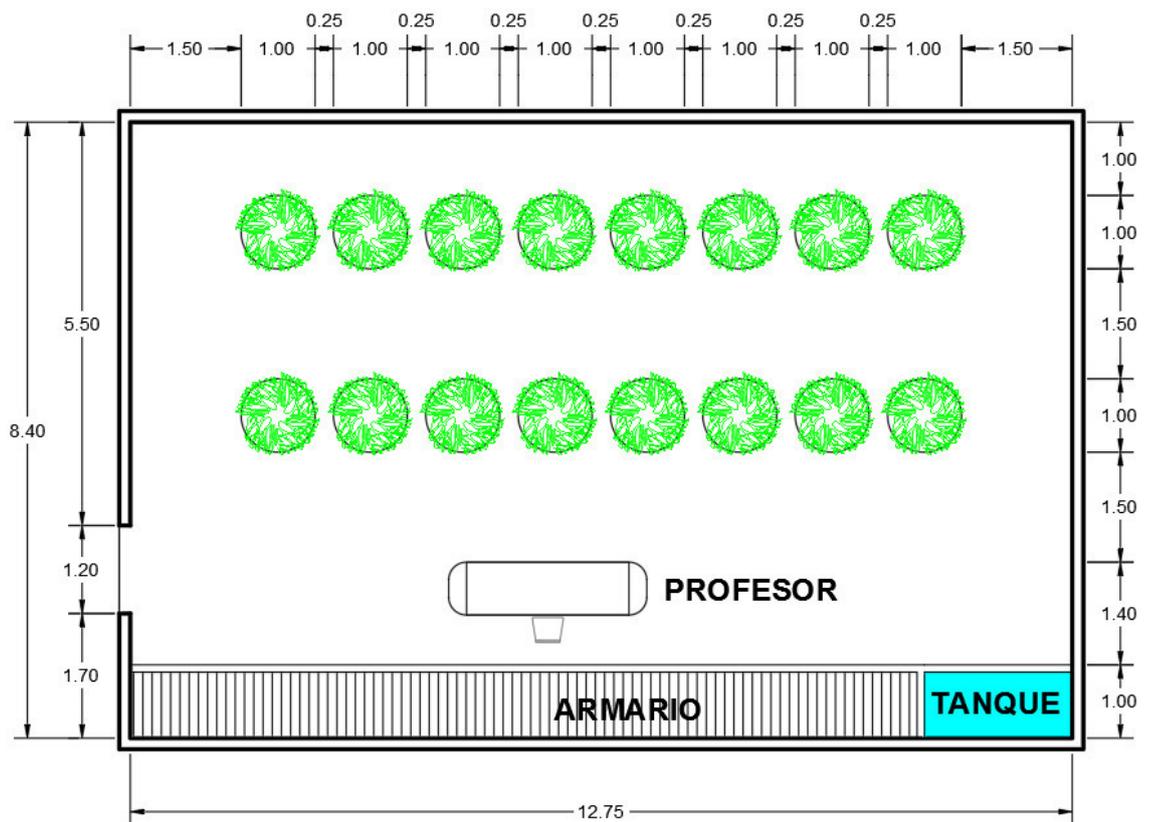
Planta, taller hidropónico sistema de columnas.
